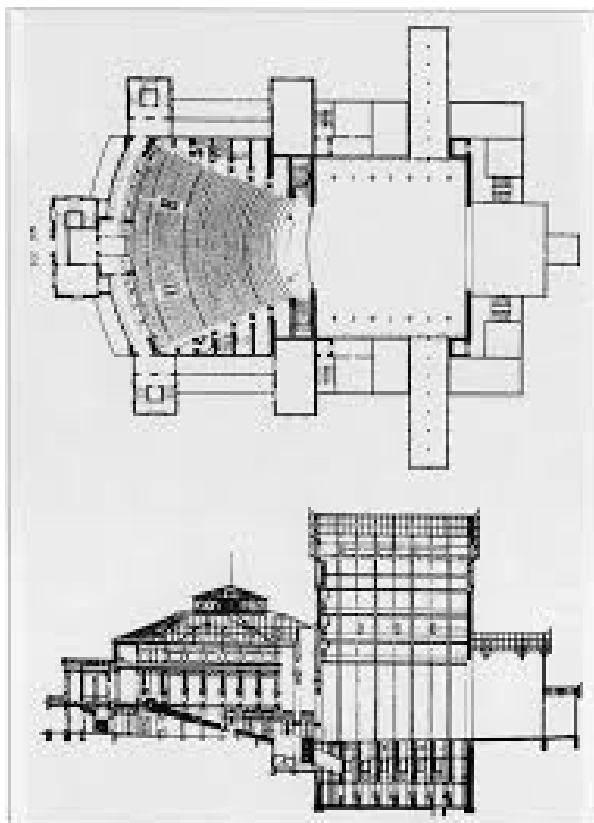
Pianta e sezione longitudinale del Festspielhaus a Bayreuth di C. Brandt, 1876
